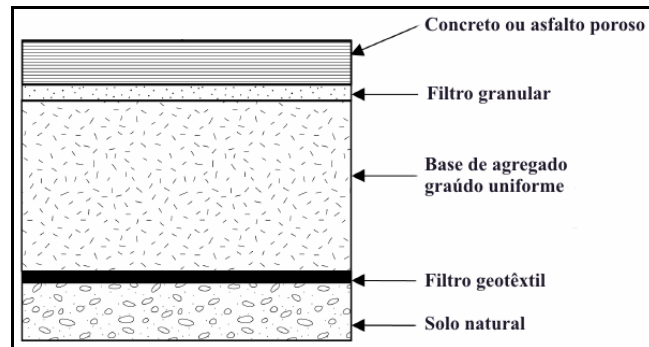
Perfil vertical de pavimento poroso (traduzido – NJDEP, 2004).
